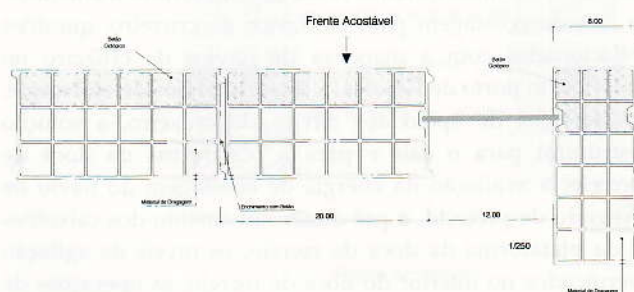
Pormenor de ligação entre caixotões na zona em que a largura de cais varia, IHRH (2007).
